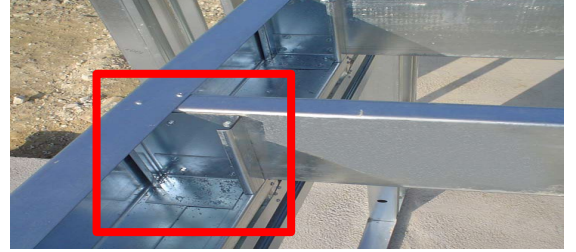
Döşeme kirişlerinin yerleştirilmesi (Installation of floor beams) (Taşkiran, 2005)
